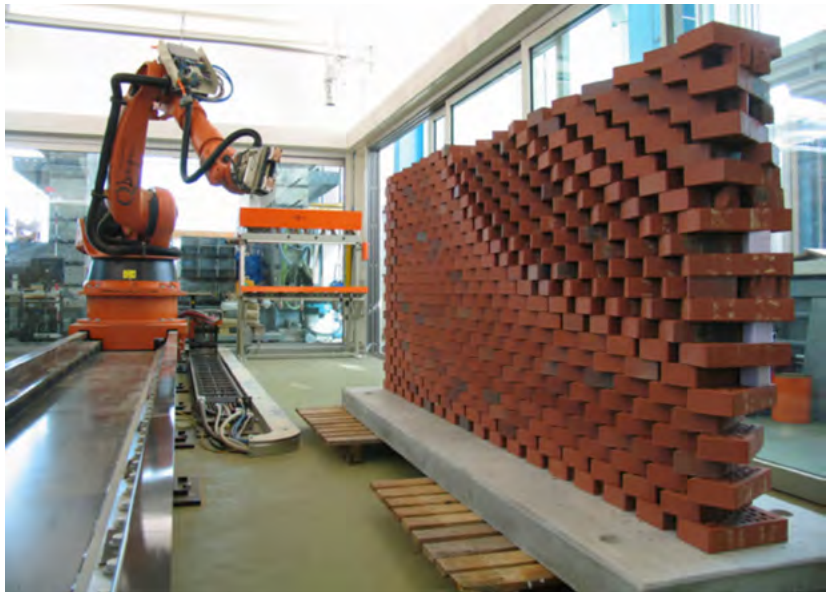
Roboter beim Aufbau einer Ziegelwand in komplexer Geometrie – Quelle [B.4]
